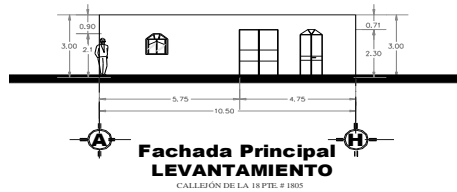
Levantamiento de la fachada y larguero. Elaboración propia
